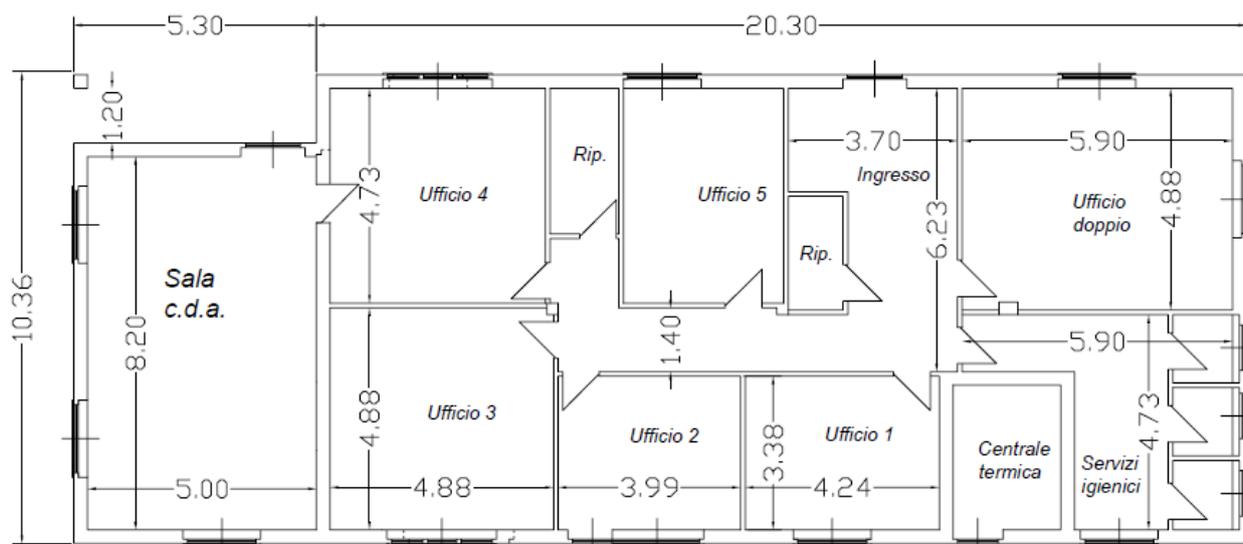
Pianta dell'edificio uffici di Borgo San Dalmazzo (le quote sono espresse in metri).
